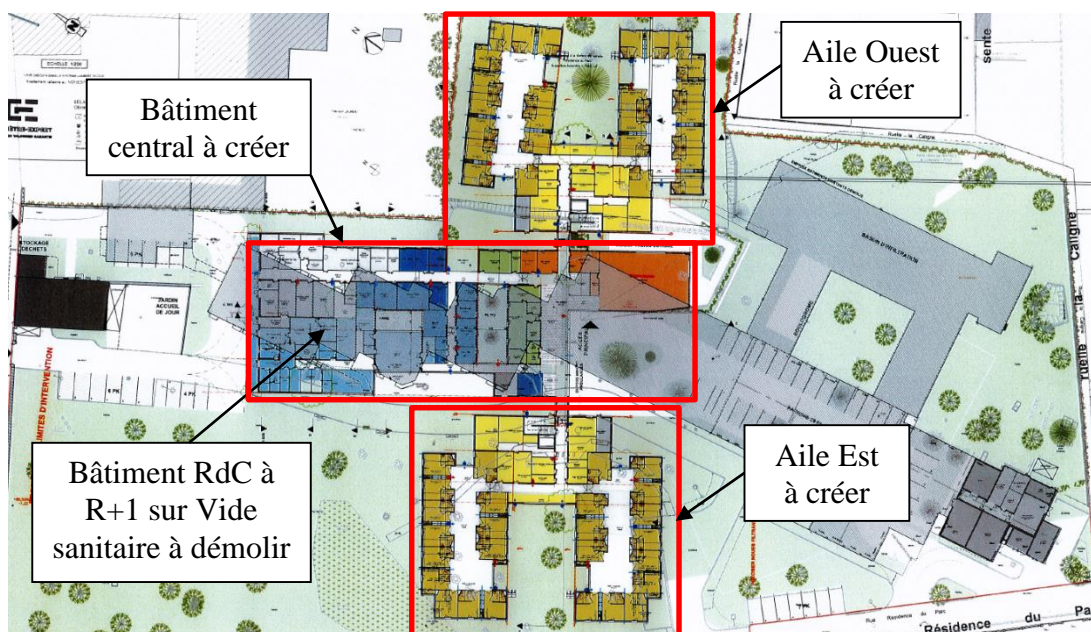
Plan de masse du projet (source CARI FAYAT, juillet 2018)
